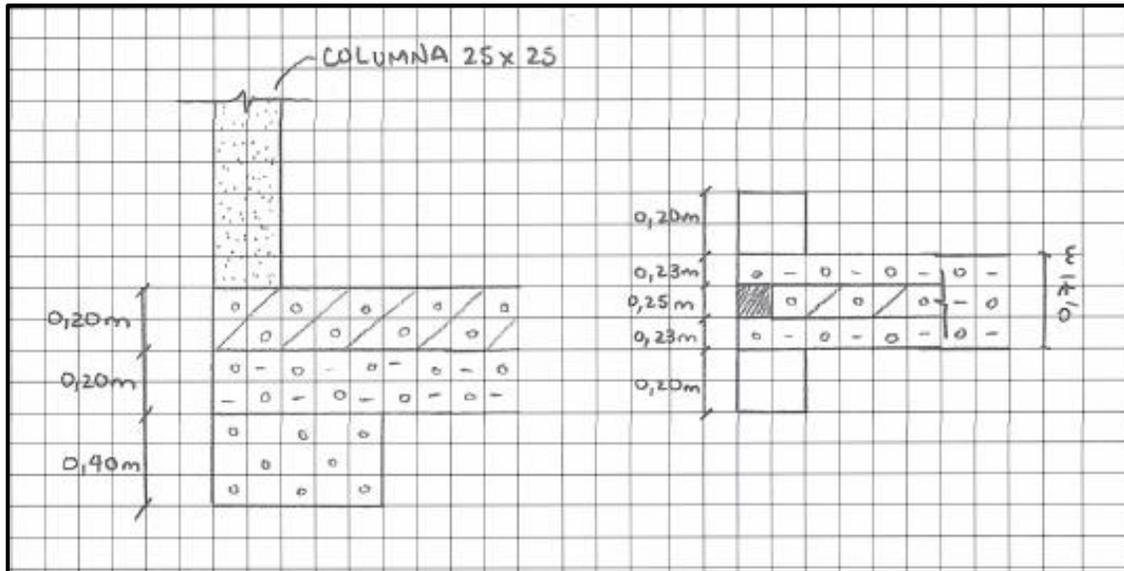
Detalle de la cimentación existente en el edificio de la sede del SENA – Edificación No. 3 Tanque.
